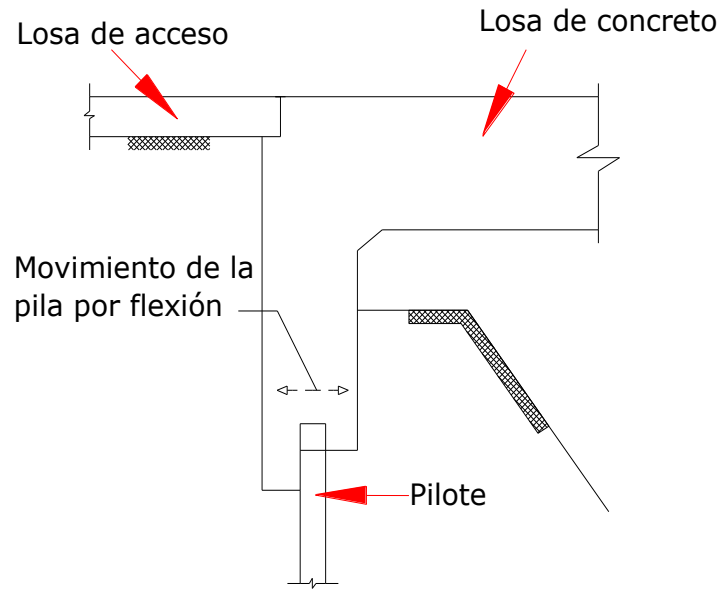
Estribo integral, tipo remate, soportado por pilotes
